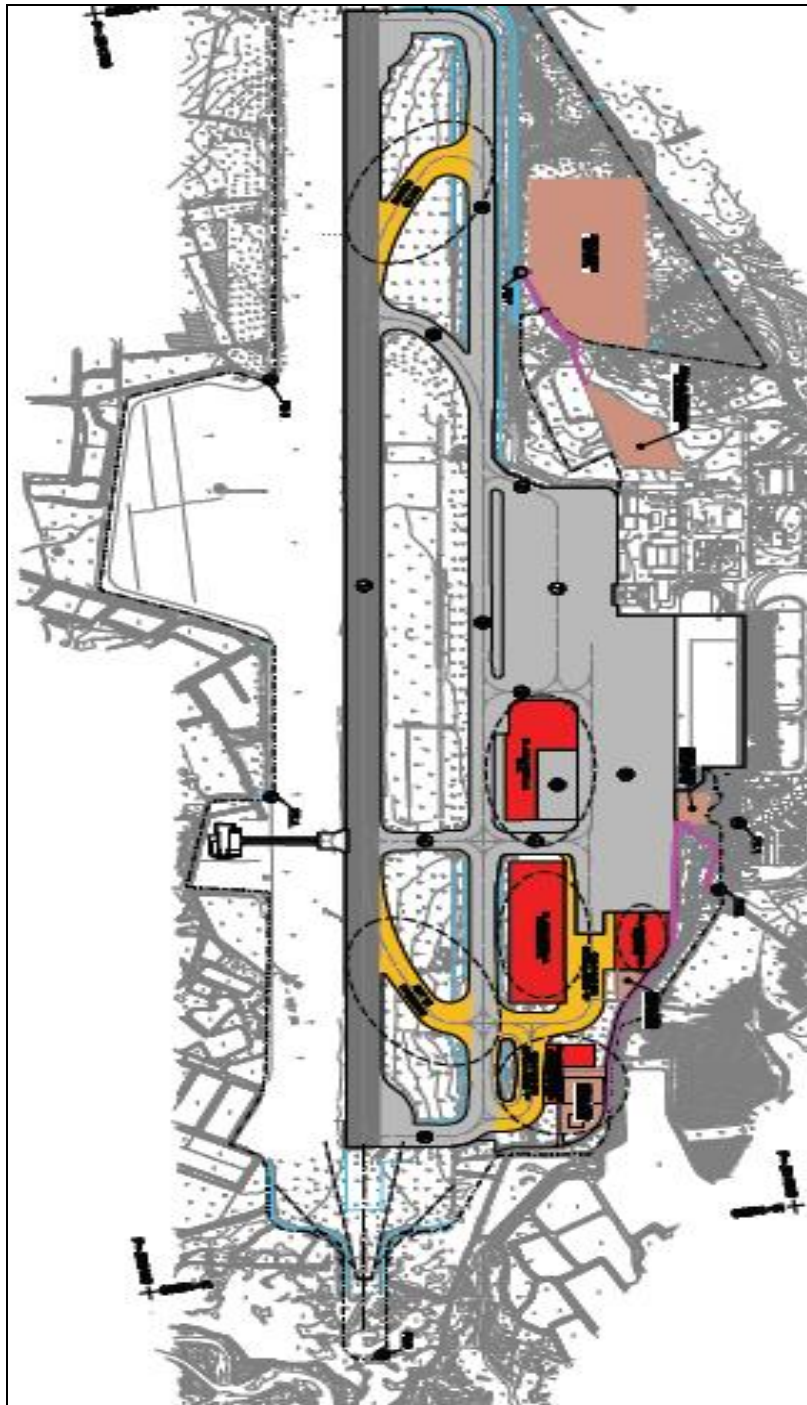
Planta Geral de pavimentos (MDJ, 2008)
